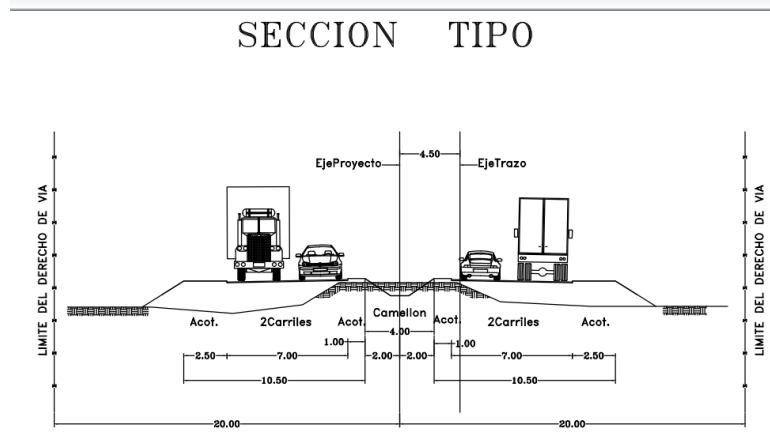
Sección Tipo en la Planta de Kilómetro
